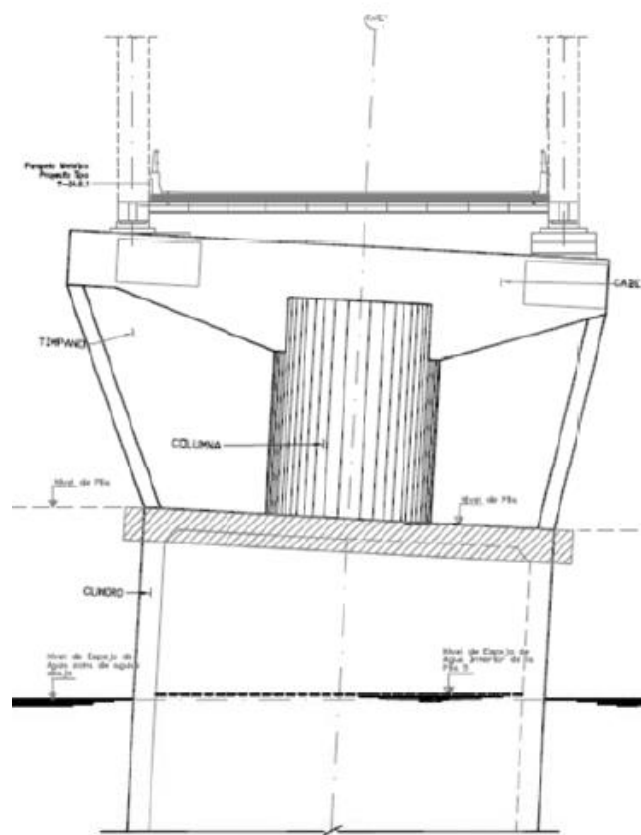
Croquis de la pila inclinada desde el Estribo 1. Cortesía de Ineco.
